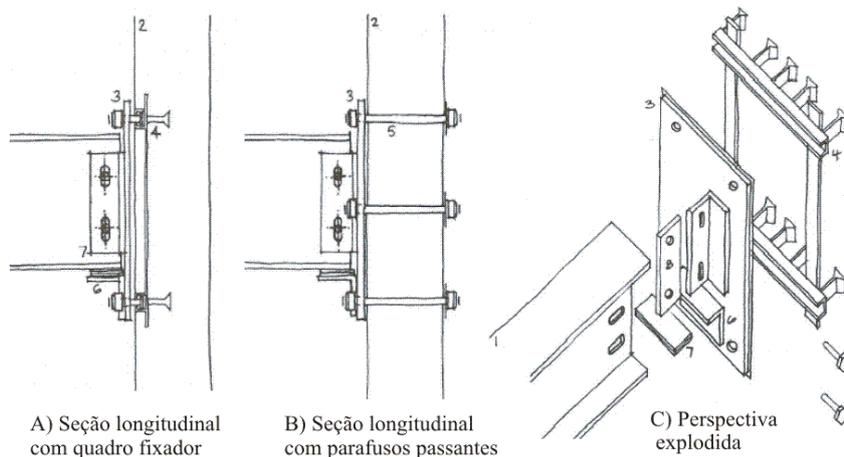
Opções de interfaces entre viga de aço e parede de concreto com quadro ou protensão.
